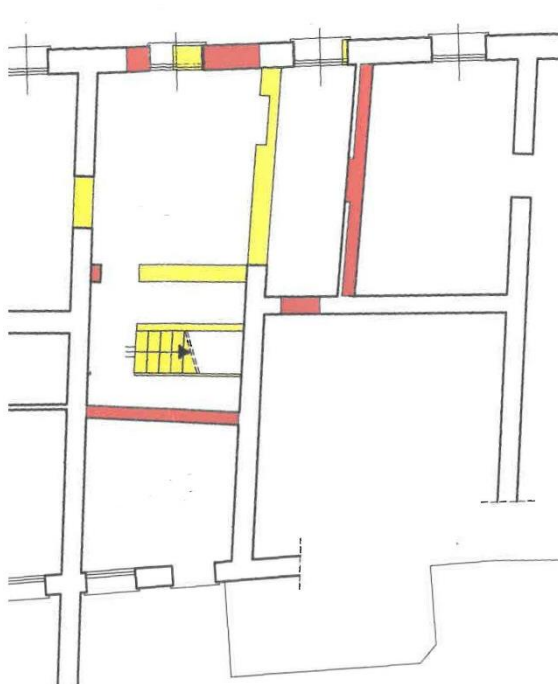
Pianta piano terra blocco D - Stato di progetto
